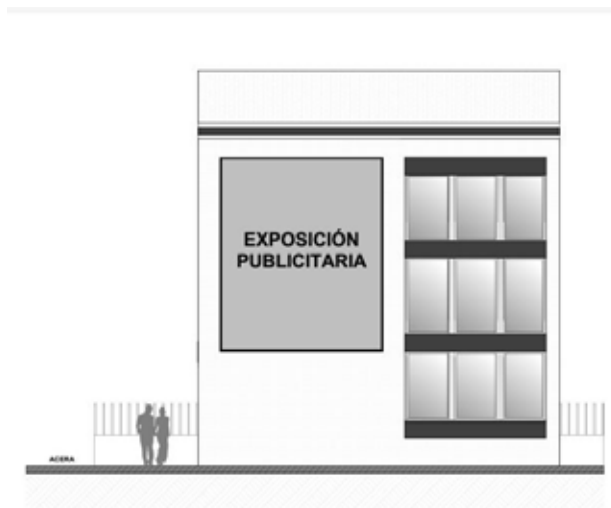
Tipo L.- Lona. - Publicidad o propaganda exterior Lona en cerramiento o fachada
